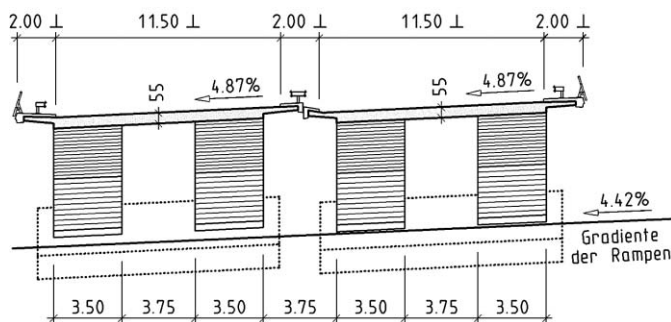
Bauwerk 1, Winnenden: Stabbogenbrücke, Querschnitt B-B
